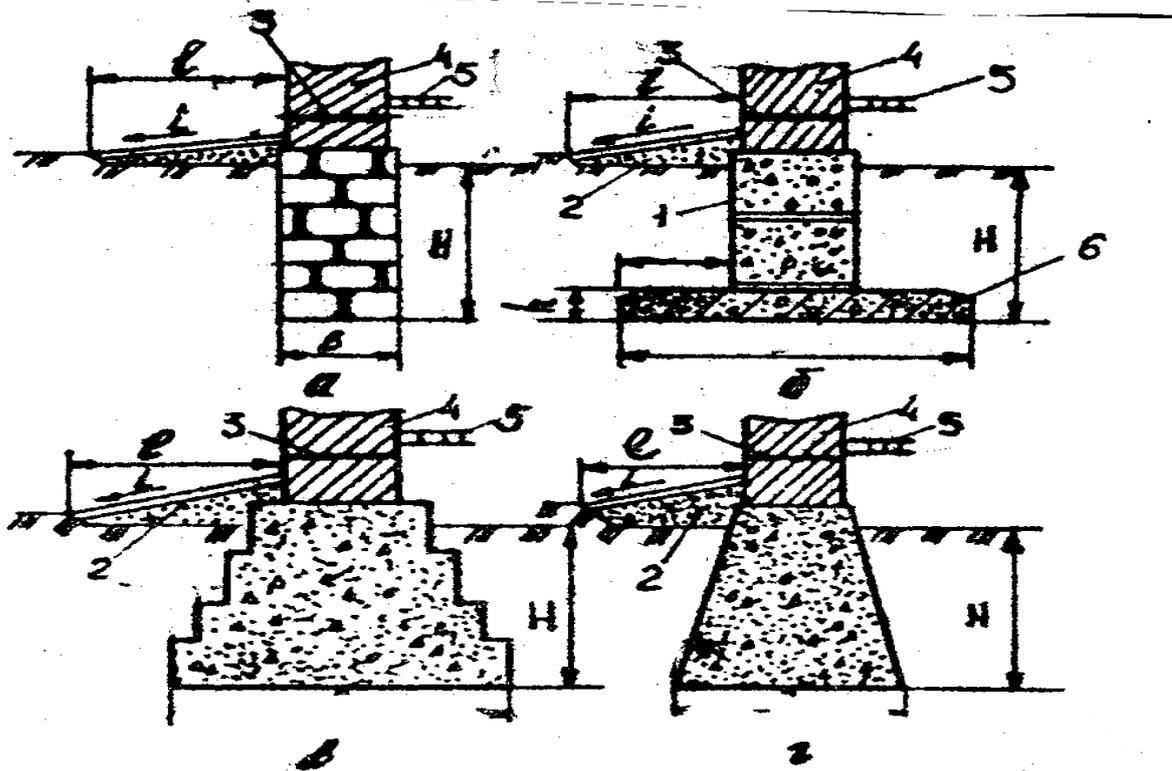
Конструкции ленточных деталей: а - прямоугольный ; б - прямоугольный с подушкой ; в - ступенчатый ; г - трапецидальный: 1- фундамент (а - бутовый б, в и г - бетонный); 2 - отмостка; 3 - горизонтальная гидроизоляция; 4 - стена здания; 5 - пол здания; 6 - подушка фундамента: а - вынос подушки; б - ширина подошвы; Н – глубина заложения фундамента; h -толщина подошвы; е - ширина отмостки; i - уклон отмостки)
